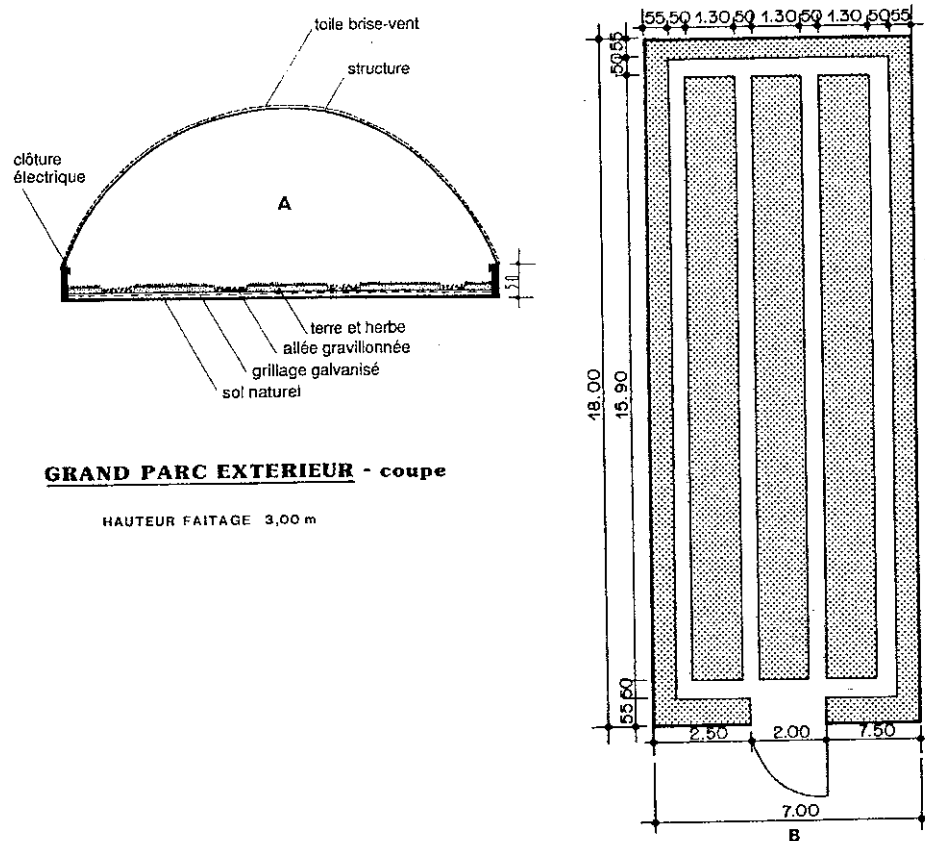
Vue en coupe (A) et en plan (B) d'un grand parc (4)
